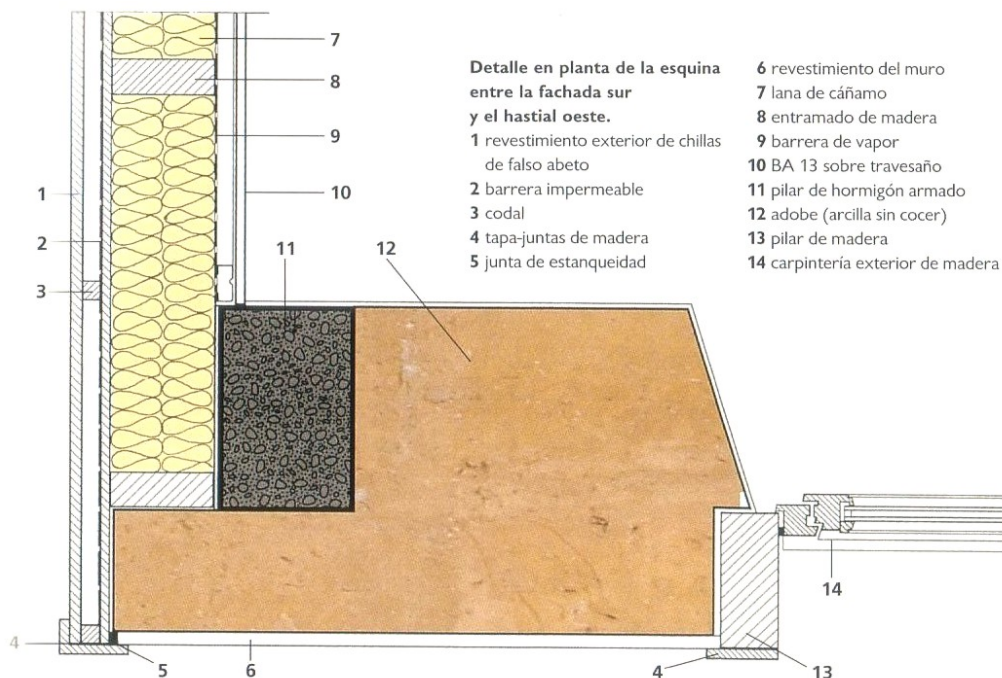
Detalhe da construção. Savatierra, Rennes, Francia
